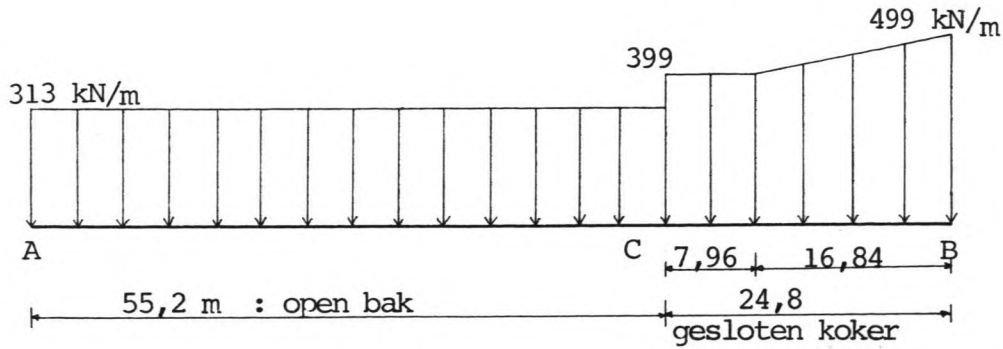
A : Eigen-gewichts-verdeling. Zonder ballastwater en trams, met ballastbeton, rails en installaties. Gewicht in kN/m, maten in m.
